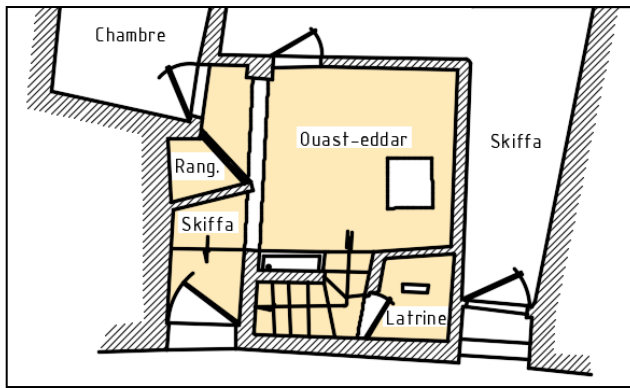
Douira sur le plan. *Source : plan modifié par l'auteur.
